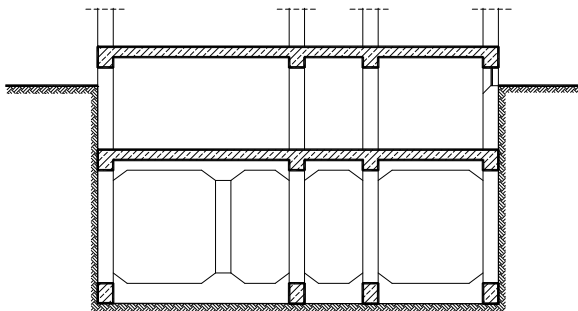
Betonarme ayak temellere ilişkin tipik bir örnek
